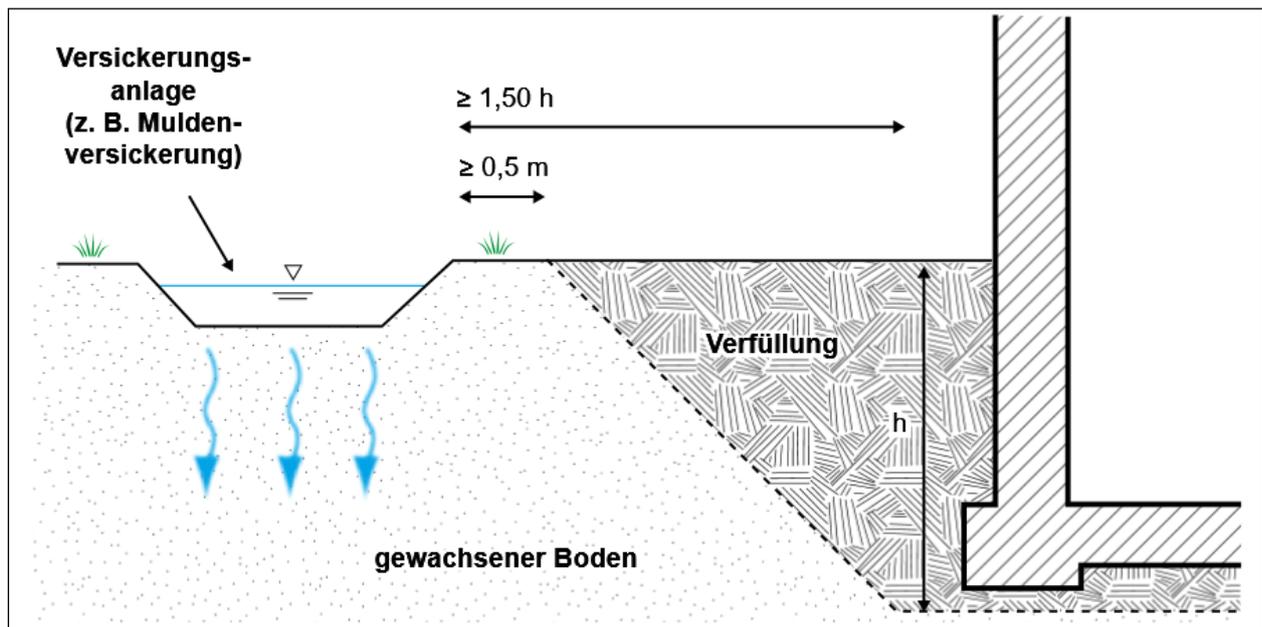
Prinzipskizze Bauwerksabstand dezentraler Versickerungsanlagen [L 19]
